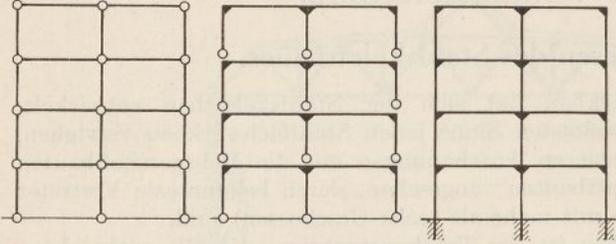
340. Ausführungsformen des Stahlskelettbauens.
